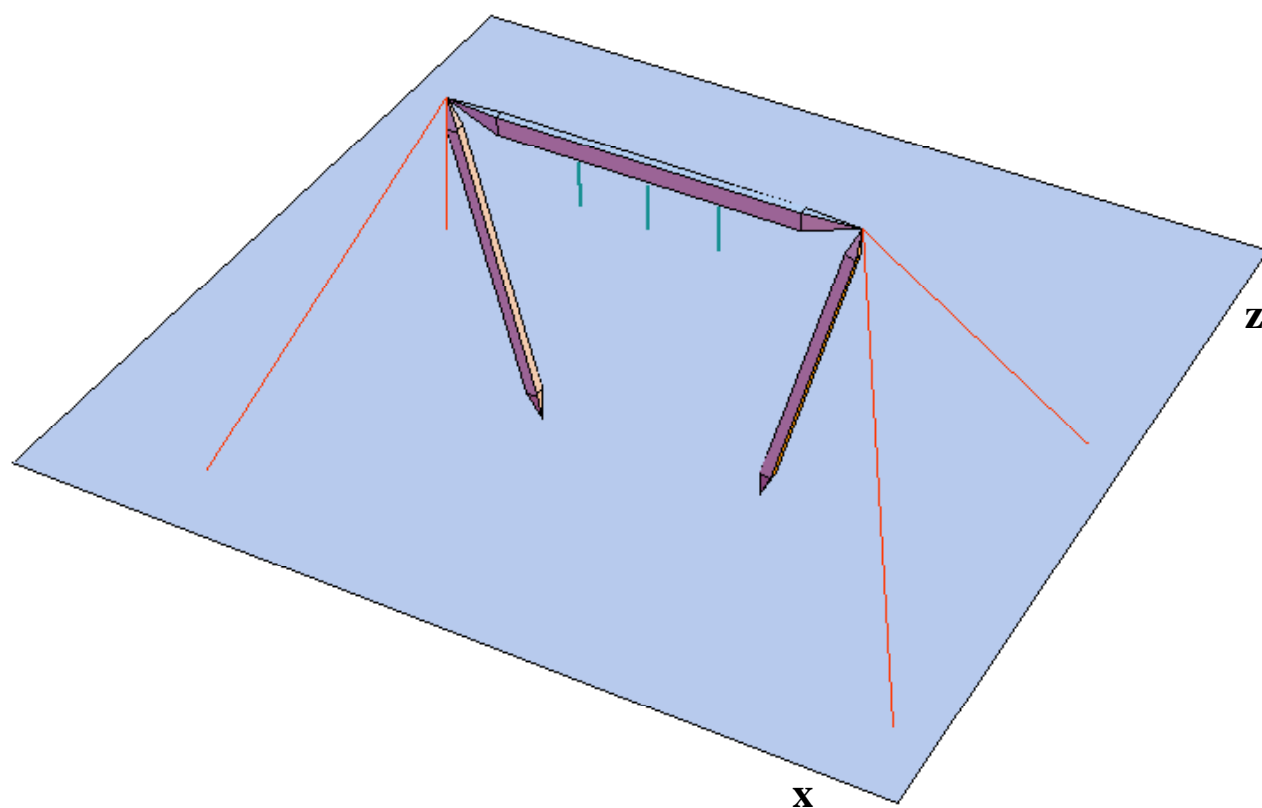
Disposição das estruturas estaiadas, a 25 °C, num vão de 500 m, em terreno plano, sem vento.
